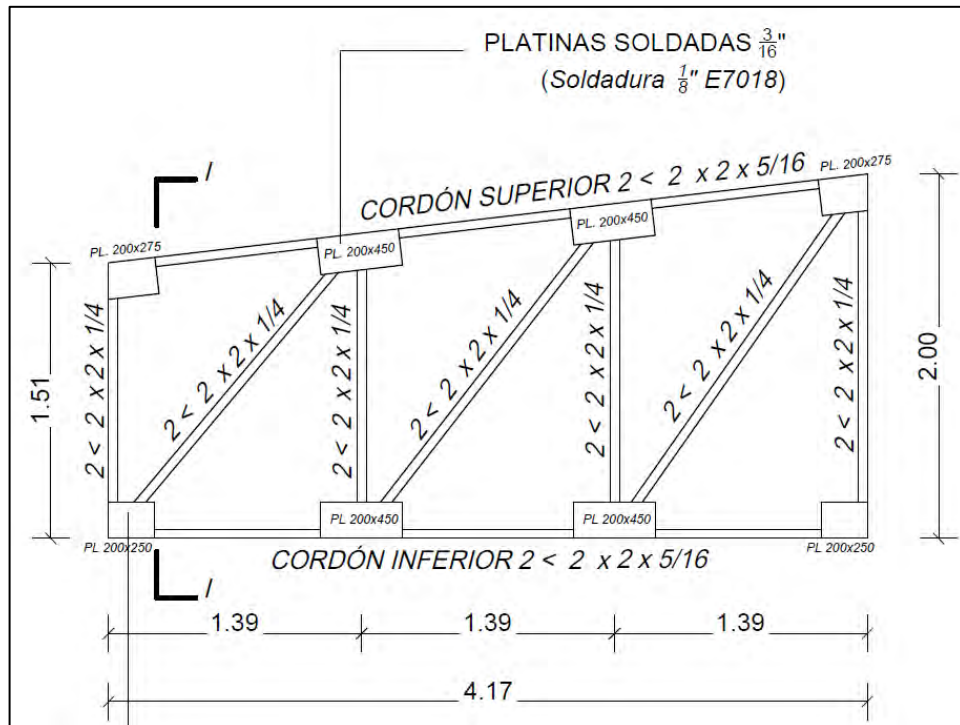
Cercha diseñada para la estructura de la cubierta de la zona 2
